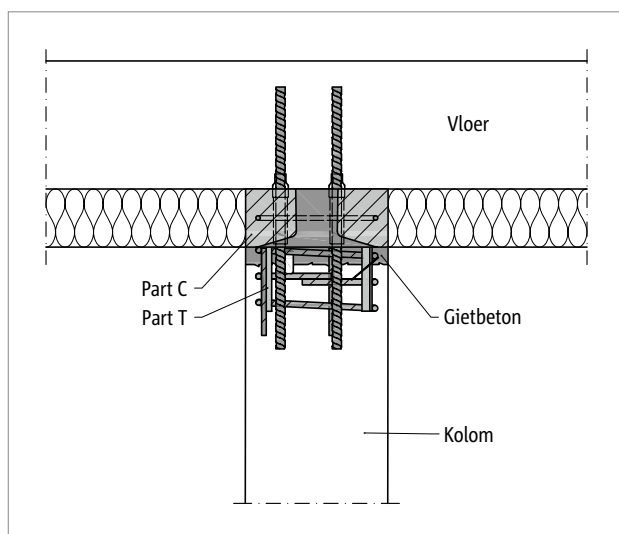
Schöck Sconnex® type P: Aansluiting binnenkolom op bovenliggende vloerplaat
